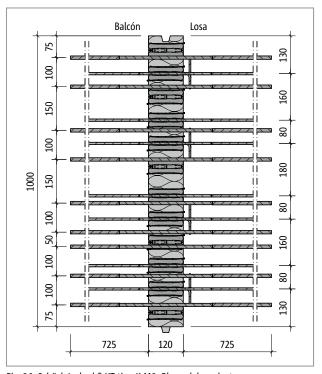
Schöck Isokorb® XT tipo K-M8: Plano del producto
